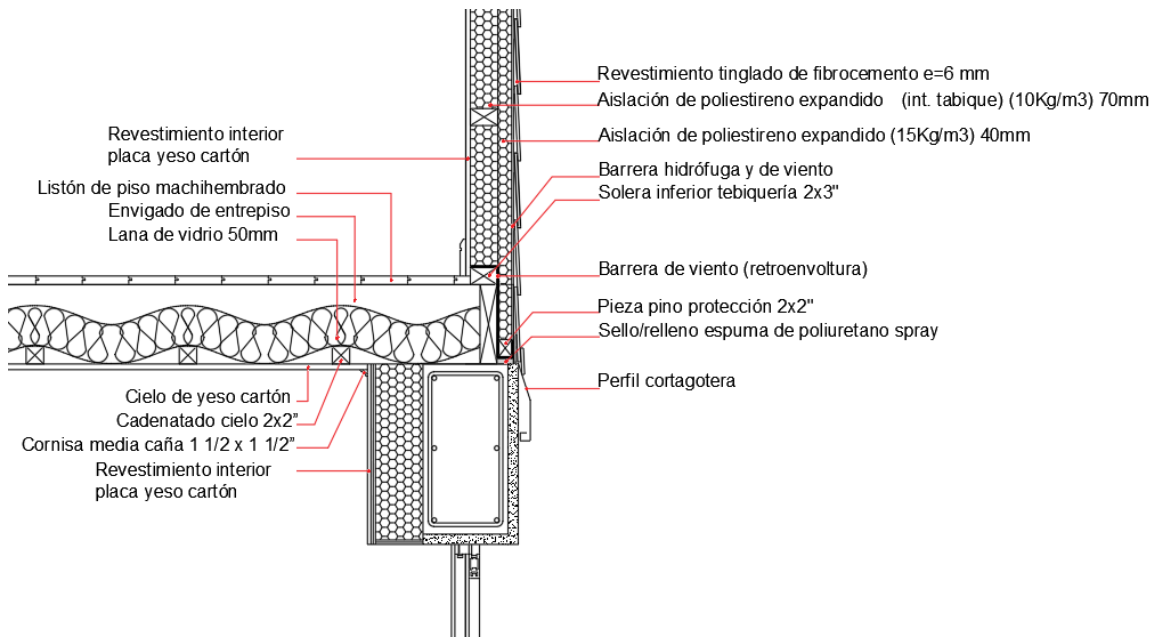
Escantillón muro primer piso- muro segundo piso . Fuente: Elaboración Propia.
